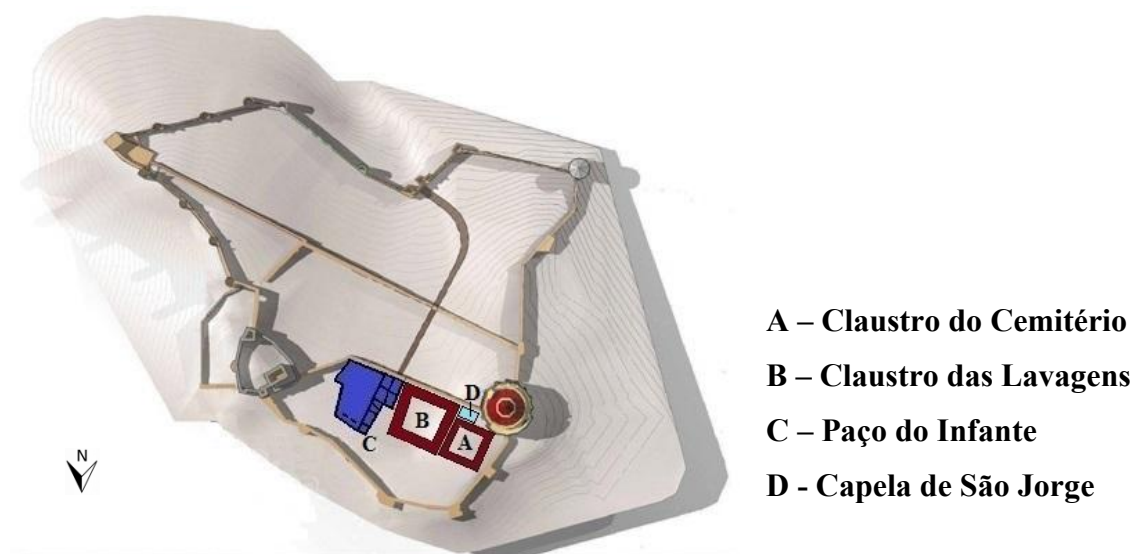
Planta do castelo templário com as edificações Henriquinas (adaptado de [22])
